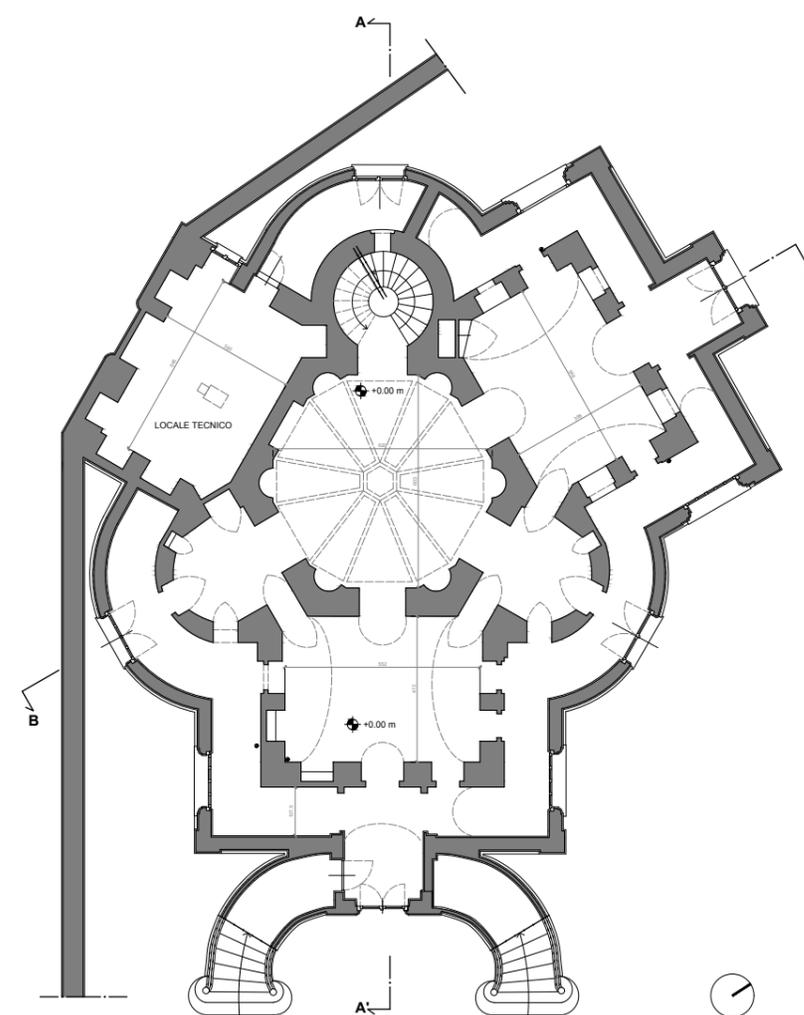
\_Pianta piano terra La Bizzarria - scala 1.200
